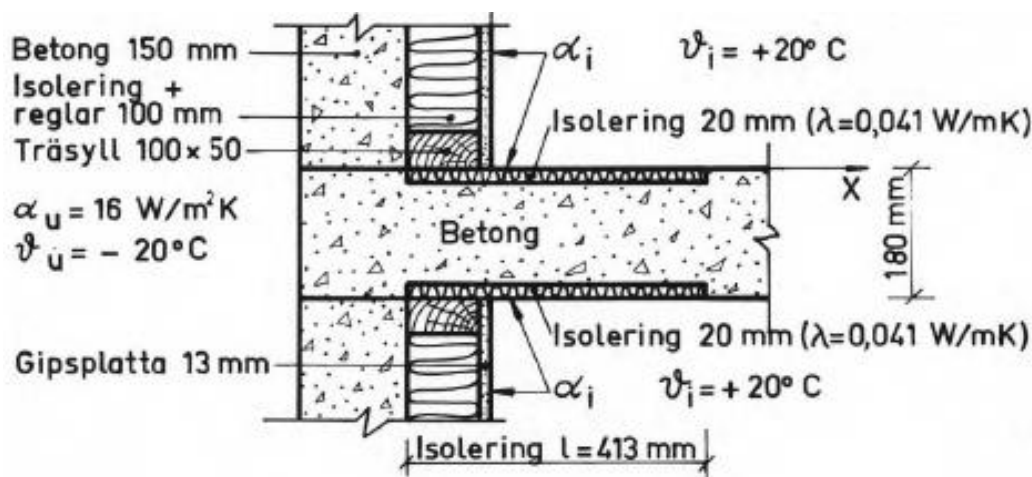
Konstruktionsalternativ vid yttervägg av sandwichtyp med ut- och invändig betong. Konstruktionen ofullständig bl.a. med avseende på fuktskydd.
